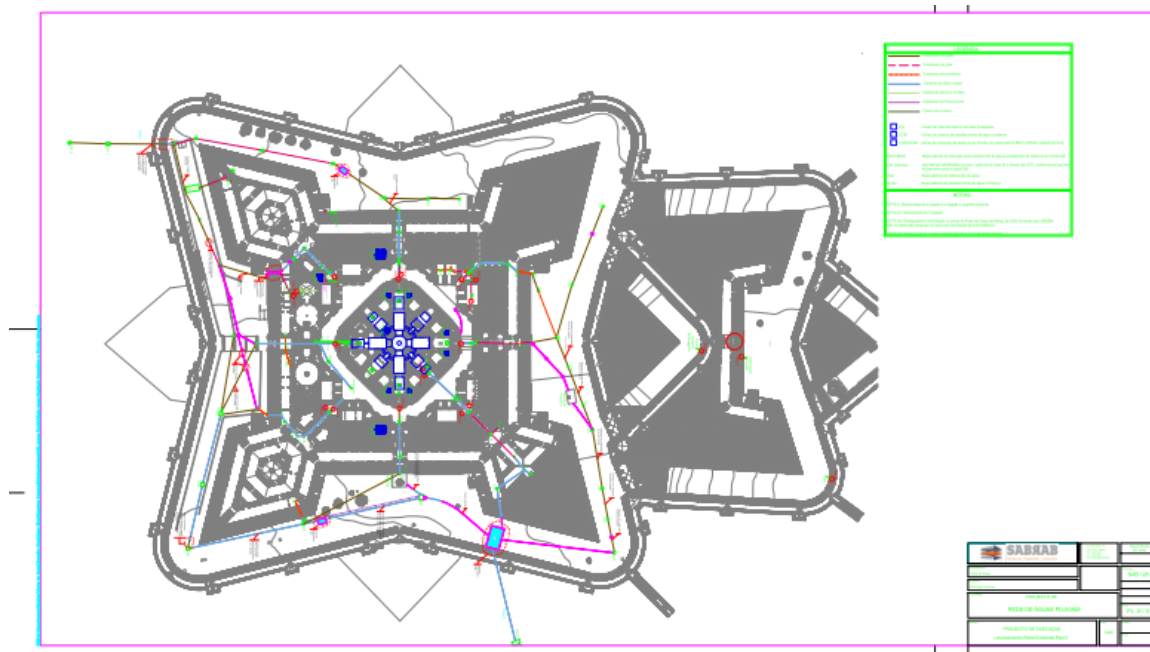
Planta com identificação de troços com necessidade de intervenção
